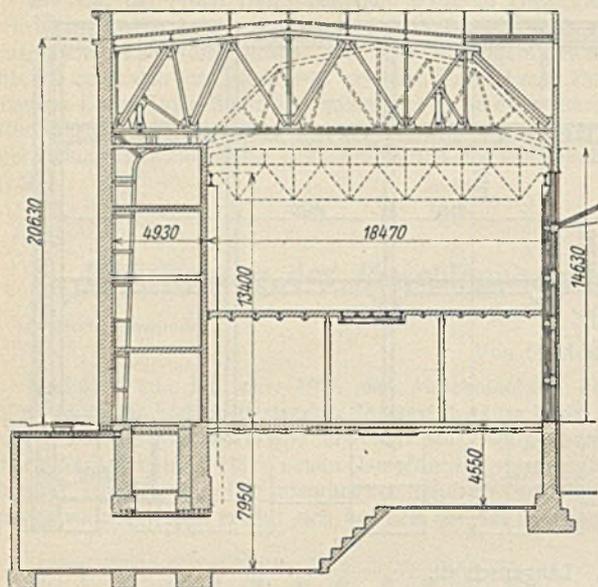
Querschnitt a—b (s. Abb. 3) mit Anschlußbinder.
